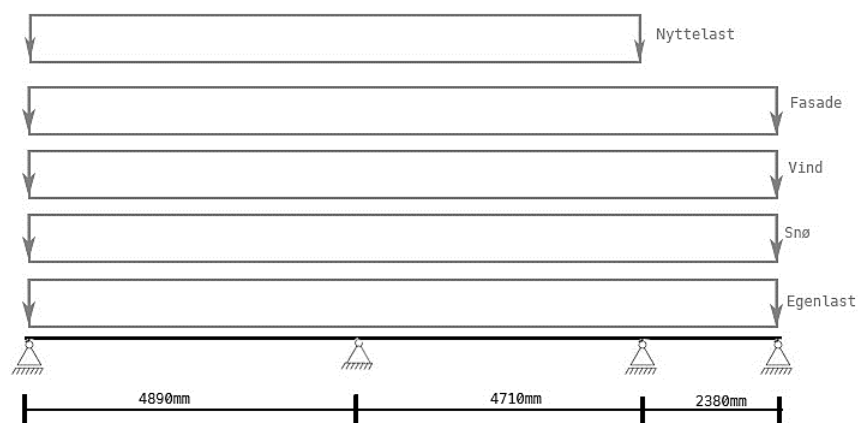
Illustrasjon etasjeskillet plan 1, Revit
